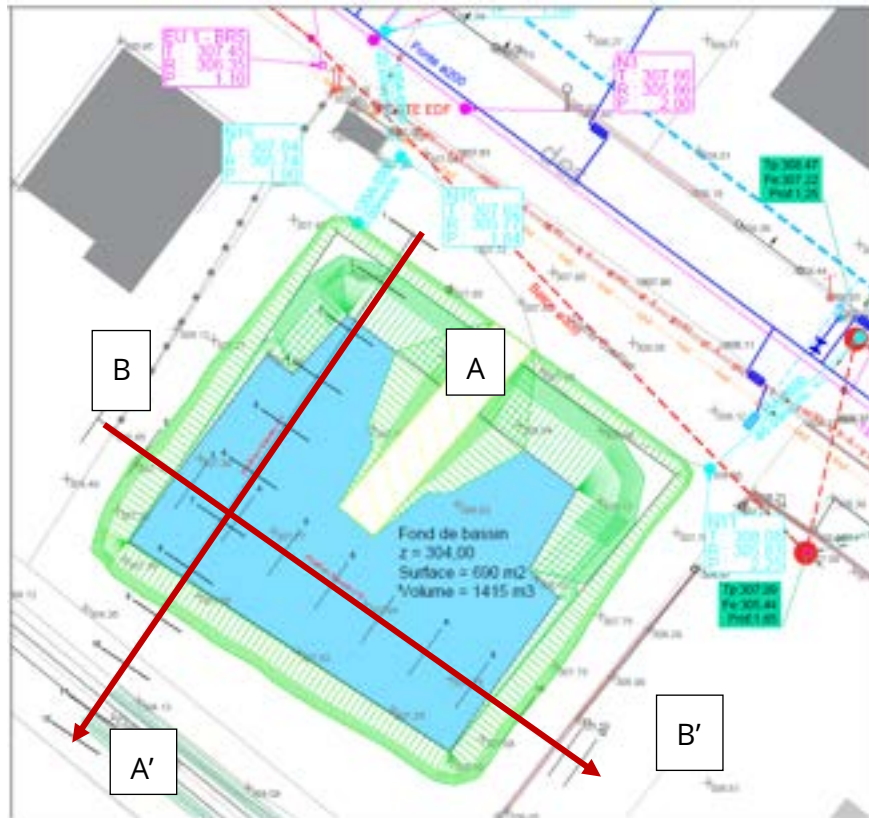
Plan de masse du projet (source : Bassin d'infiltration du Groupe Déjante)
